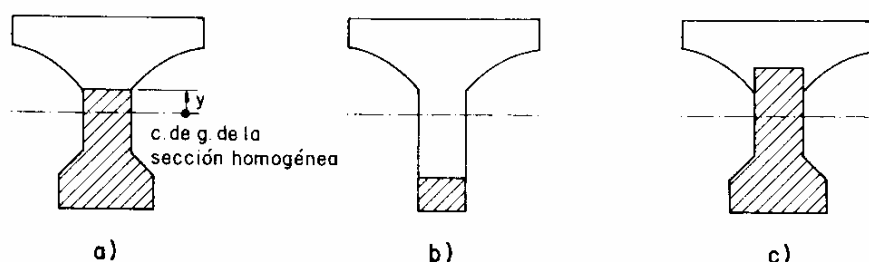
Juntas diversas entre piezas prefabricadas y hormigón in situ (Hormigón Armado / MONTOYA – MESEGUER – MORAN)
